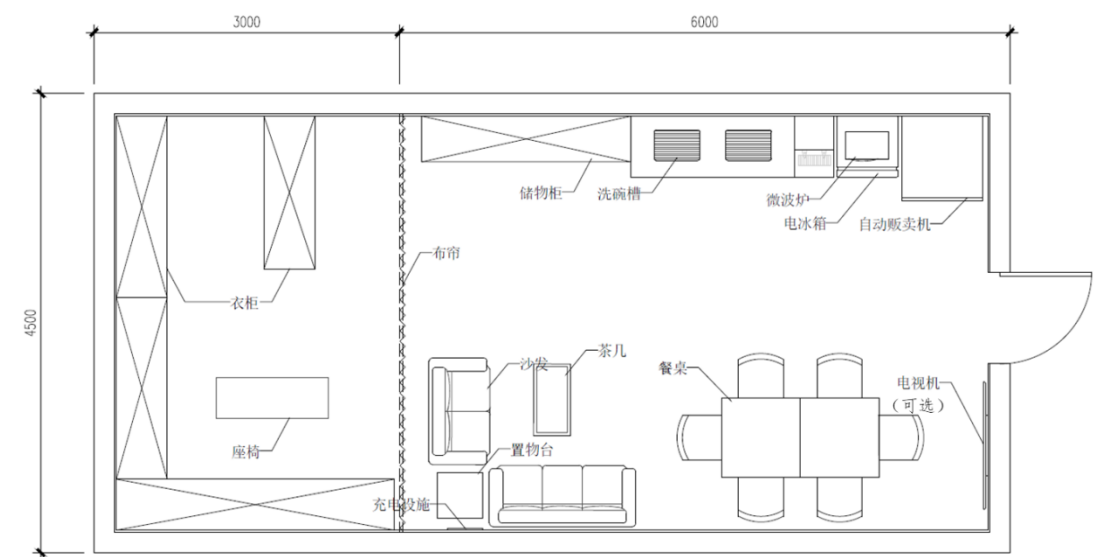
航站区共享休息区+更衣室 平面布局示意图（单位：mm）
